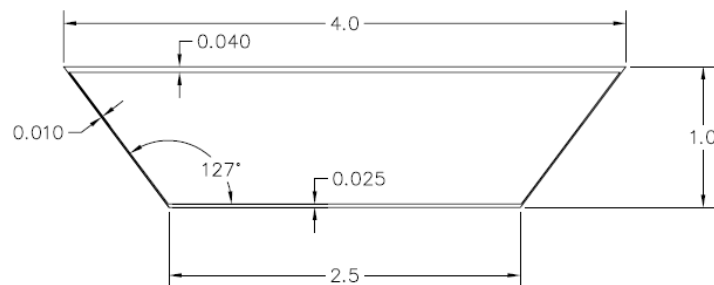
Sección del tablero con baja rigidez, ortótropa. Cotas en metros.
